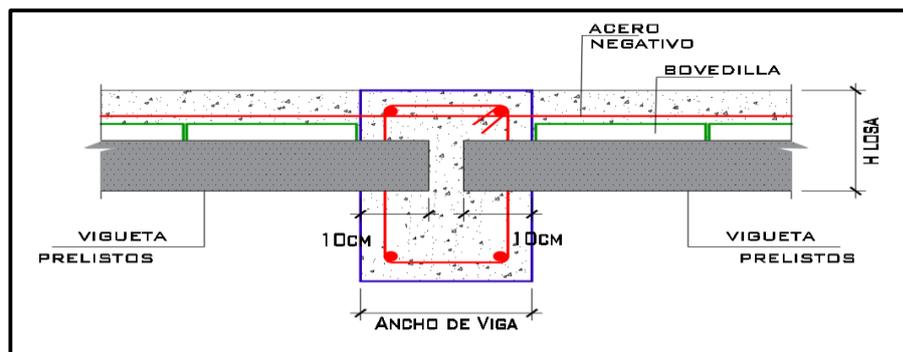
Detalle de ingreso de vigueta a viga peraltada extremo continuo.
